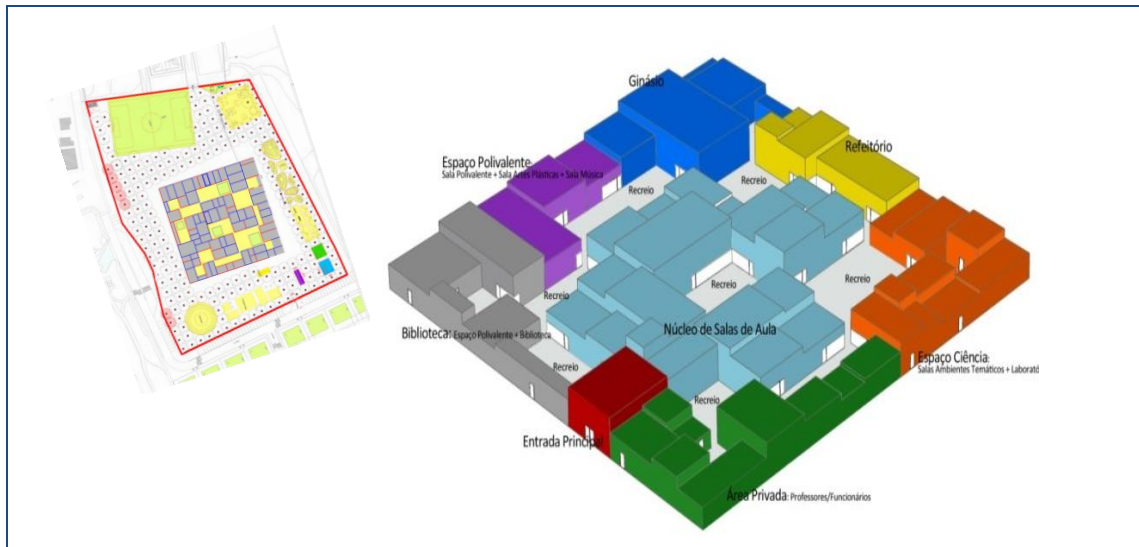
PLANTA DA ESCOLA CIÊNCIA VIVA
